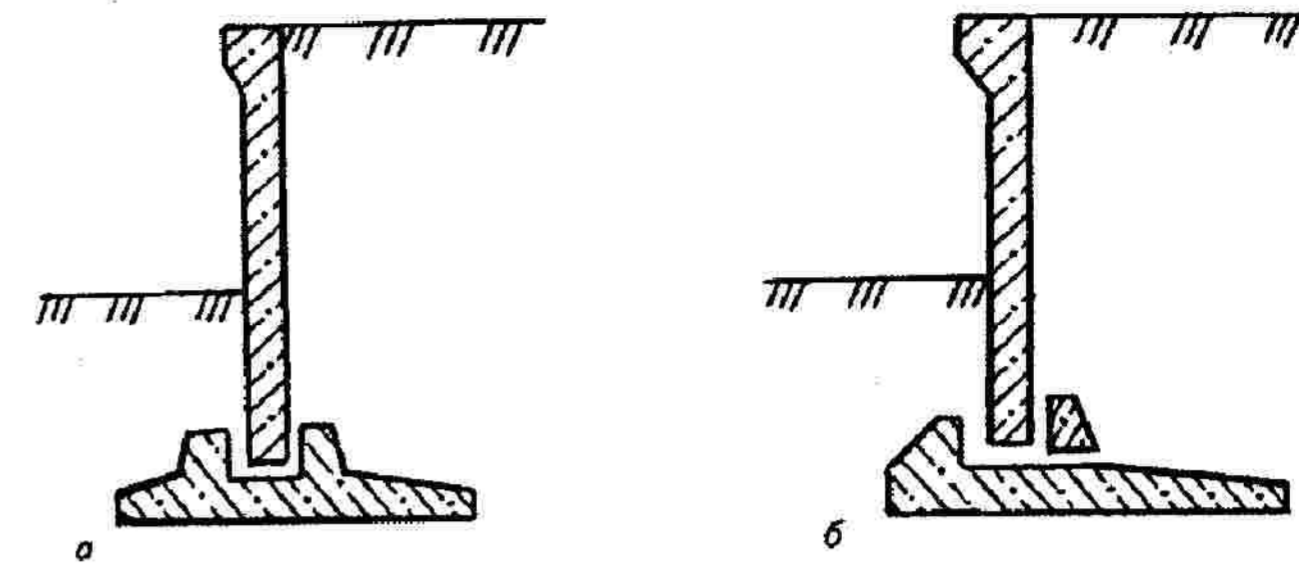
Сопряжение лицевых и фундаментных плит:
